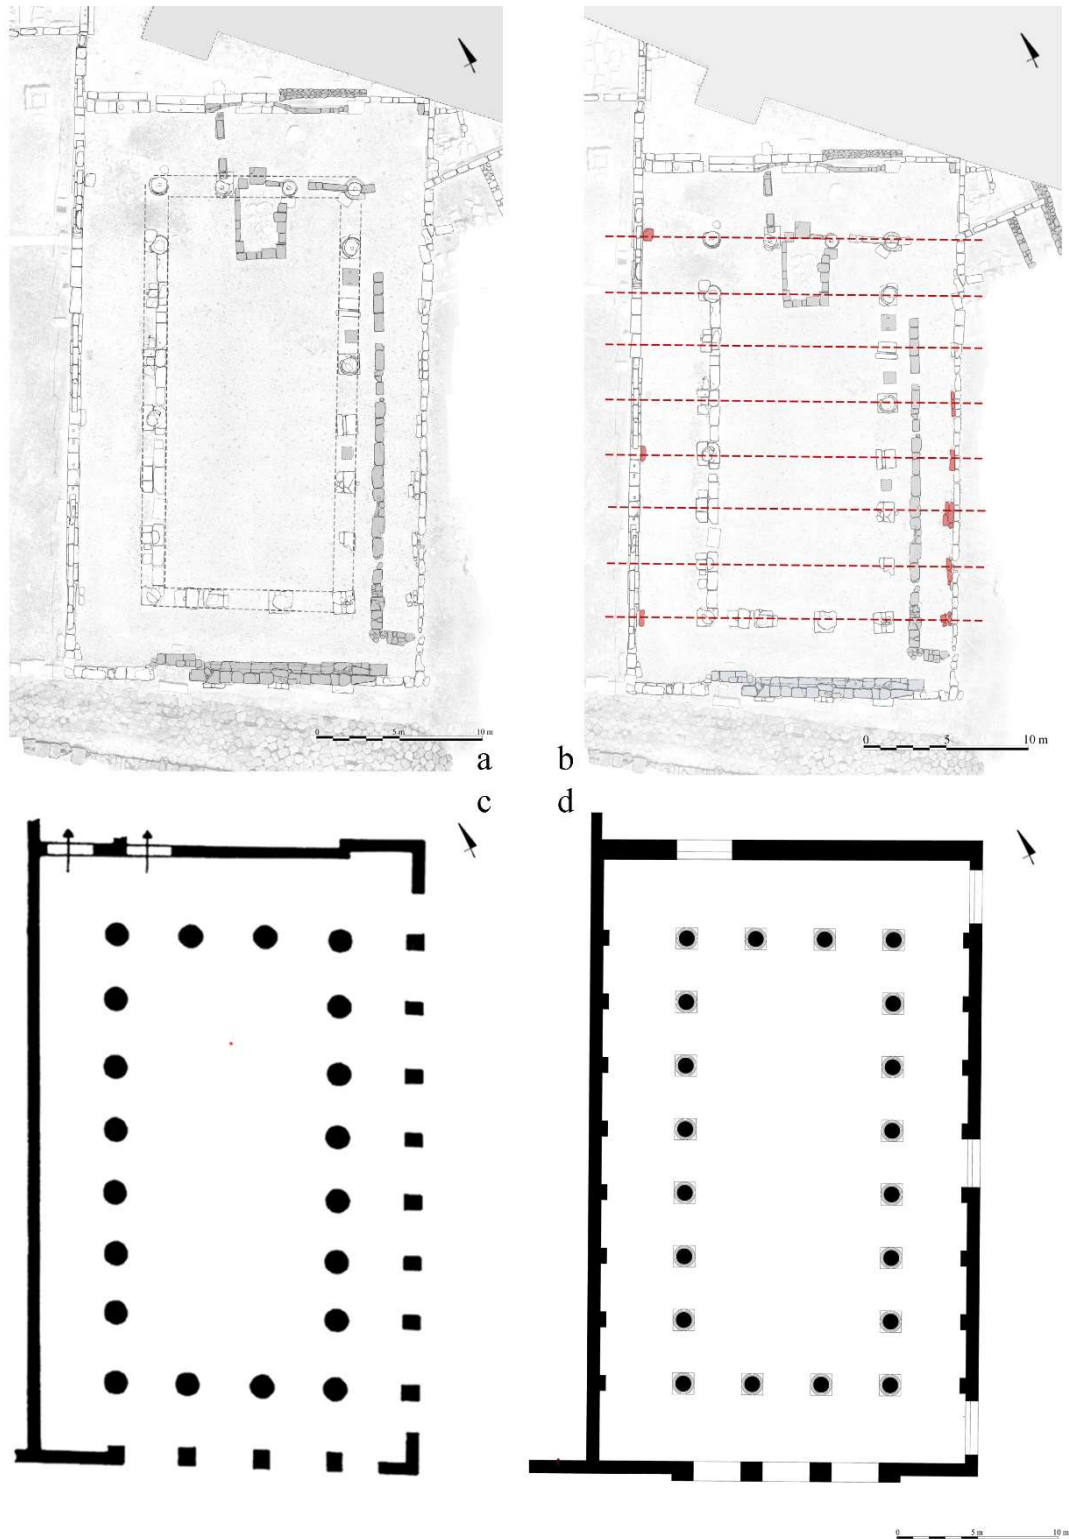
d. Egnazia, basilica civile: a. Rilievo planimetrico (elaborazione degli A.); b. planimetria con individuazione delle sporgenze attribuite a paraste lungo il muro perimetrale; c. Ricostruzione della planimetria secondo E. Lippolis (da Lippolis 1997); d. Ricostruzione planimetrica secondo gli Autori.
